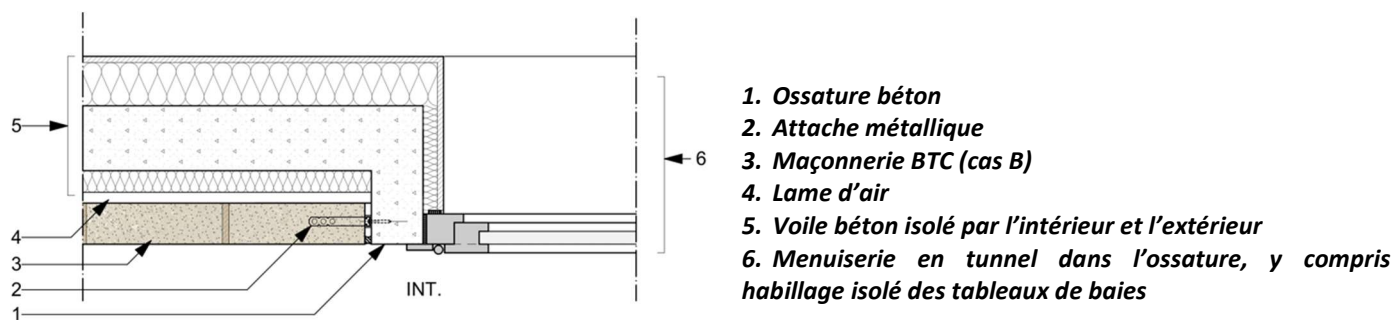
Exemple en plan d'intégration de baie en ossature béton
